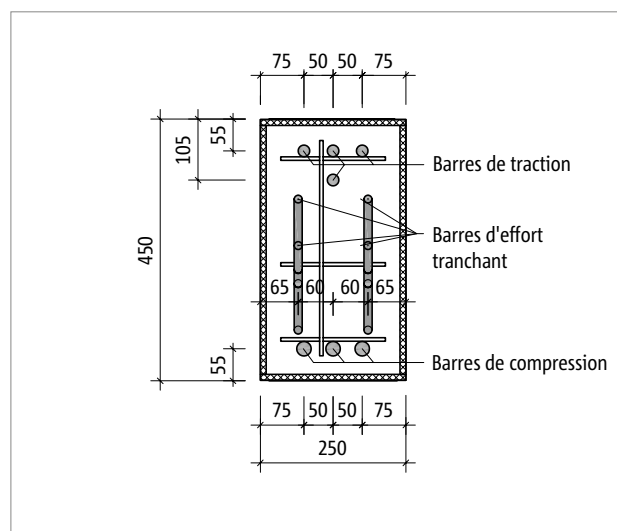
Schöck Isokorb® T Type B-M6-V2 en hauteur H450 : Vue du produit
